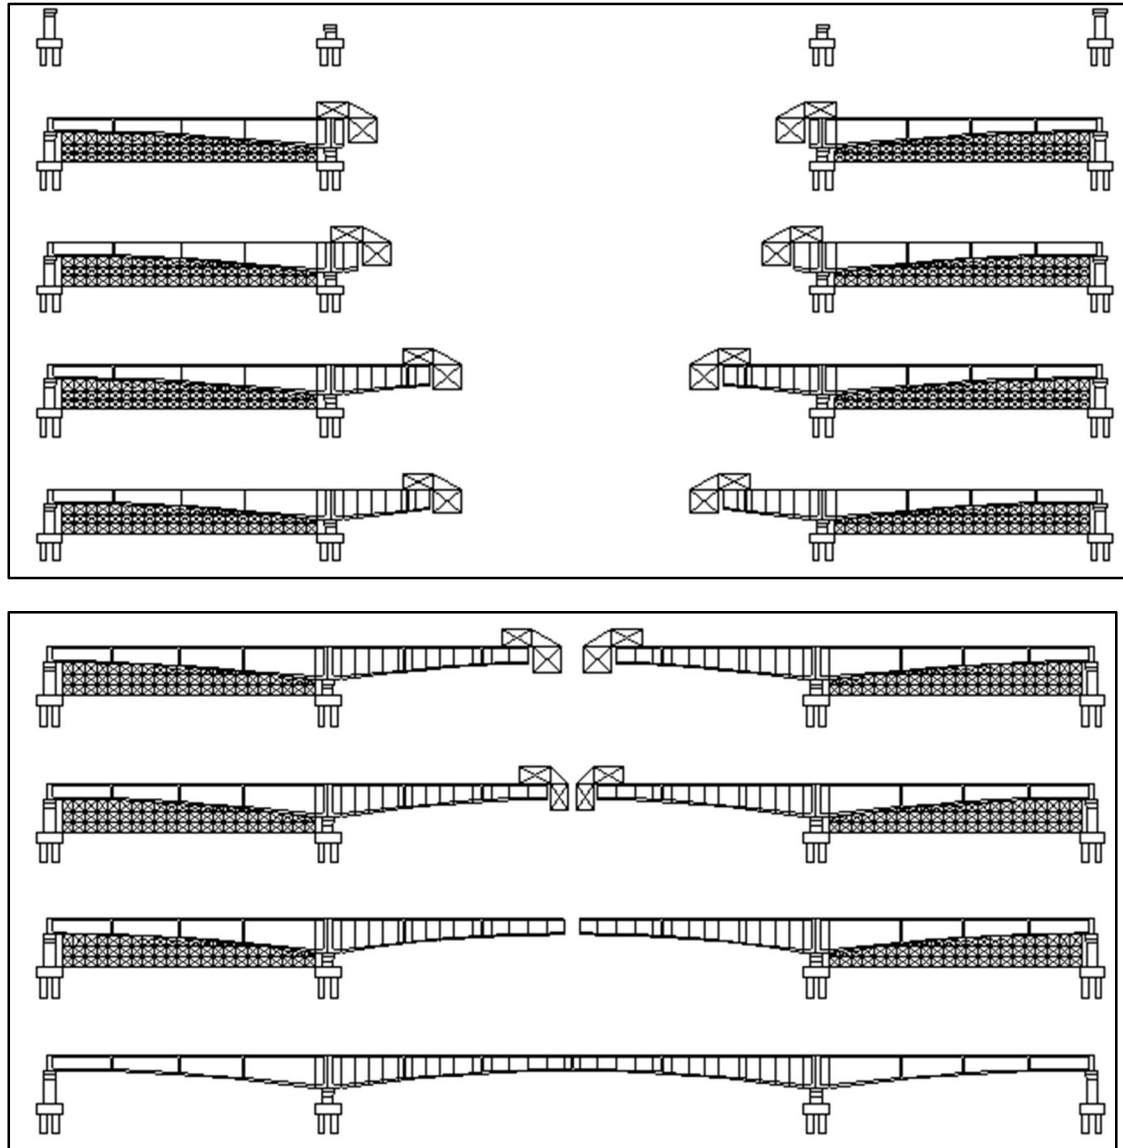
Secuencia constructiva tipo para puente por voladizos sucesivos mediante carro de avance
